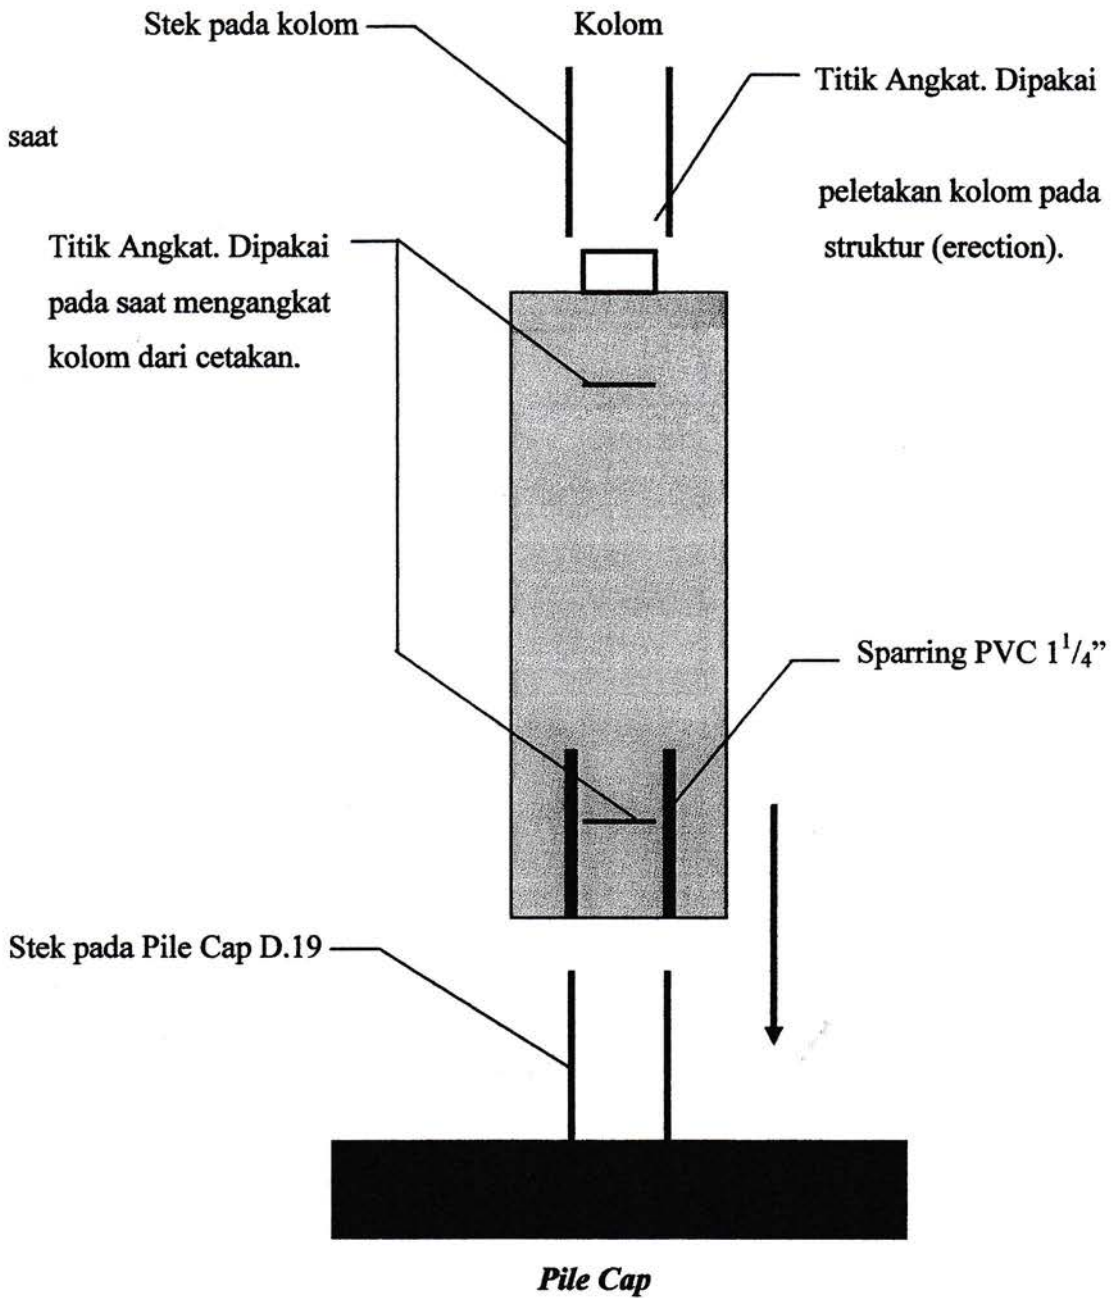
Stocking / penyimpanan kolom, serta Stek pada kolom.
